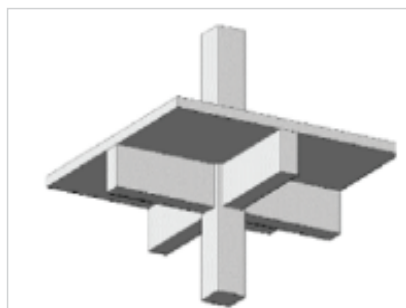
Ligação viga-pilar moldada no local com a presença de laje
